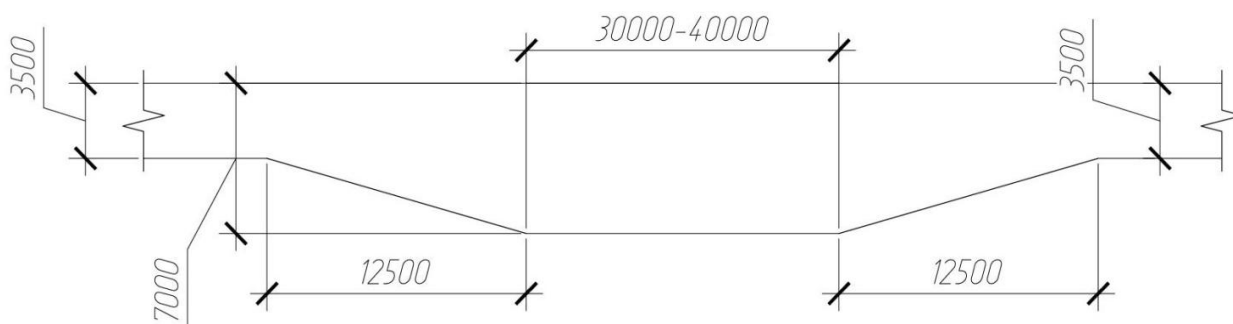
Схема расширения автодорог за счет создания дополнительной площадки
